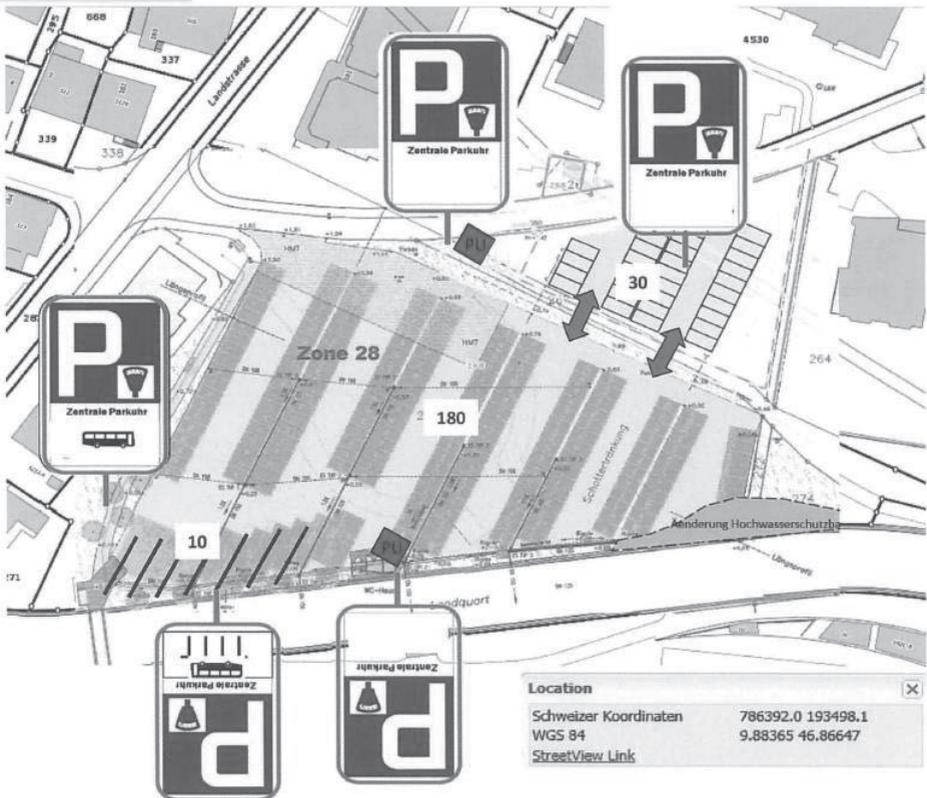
Plan Bestand Parkplätze alte Eisbahn
